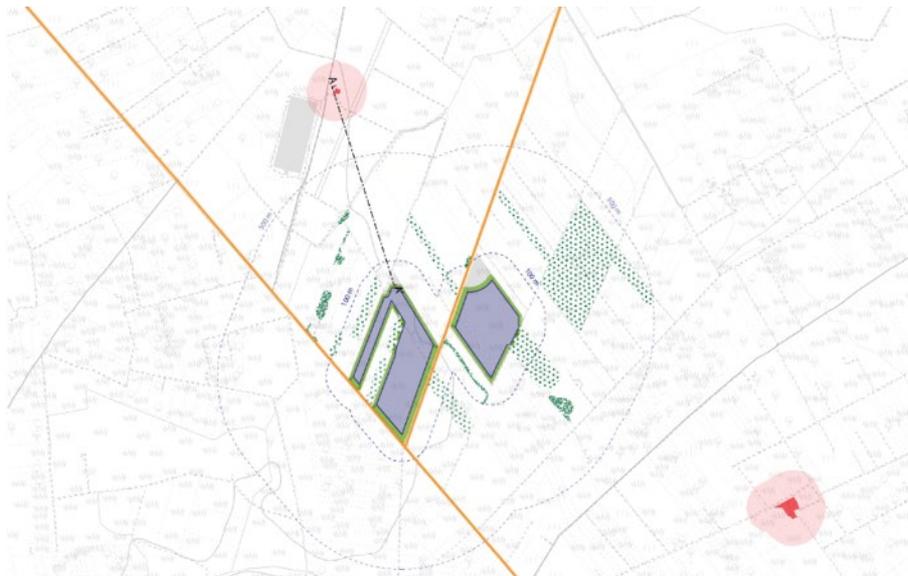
\_ Planimetria di individuazione delle fasce di mitigazione - Impianto di Brindisi
